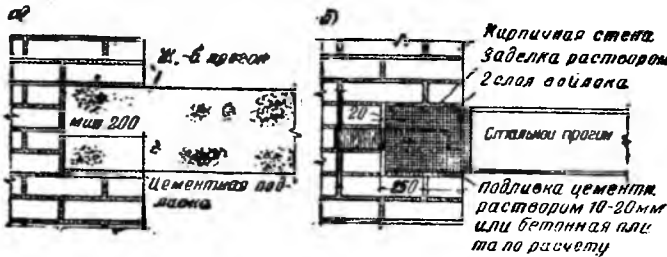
Заделка концов железобетонных и стальных балок в стены и столбы
